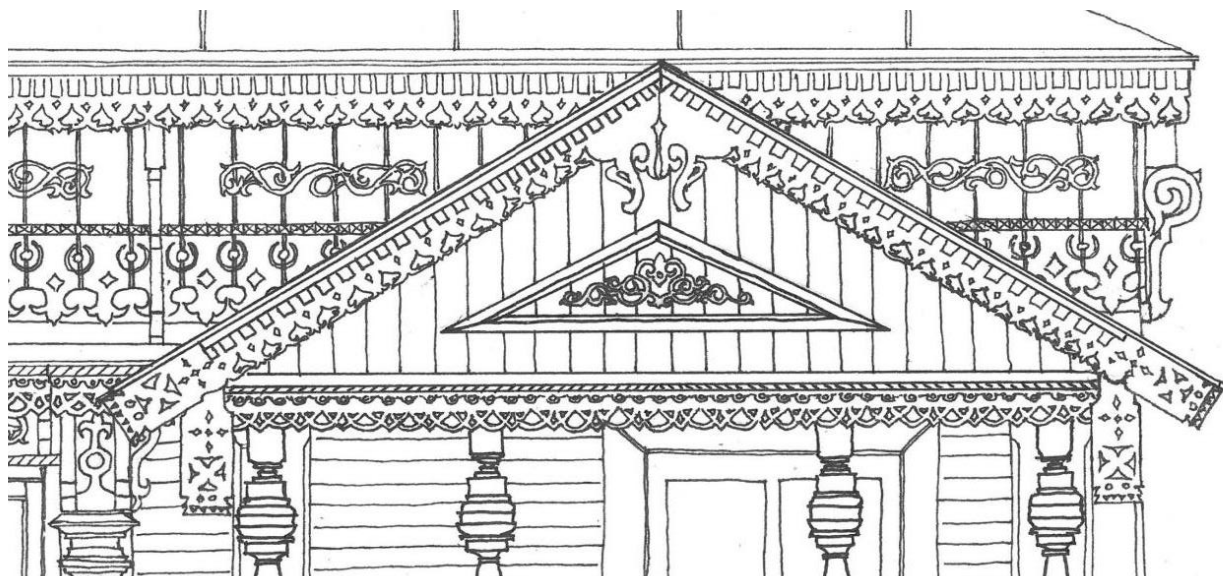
Фрагмент kroka главного фасада жилого флигеля на ул. Полонского, 13а
